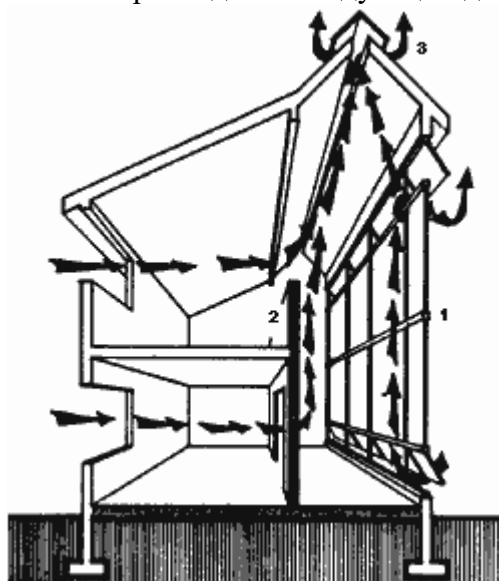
Организация усиленной естественной вентиляции здания: 1 - остекление южного фасада; 2 - массивные перекрытия и полы; 3 - фонарь верхнего света (солнечная труба) с регулируемыми вентиляционными отверстиями.
